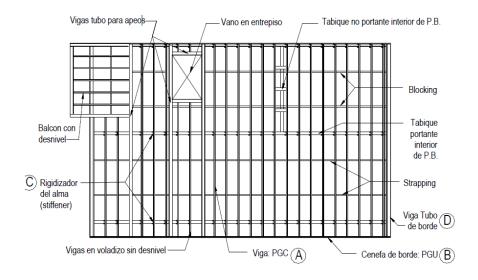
Planta de un Entrepiso de una vivienda Unifamiliar.
